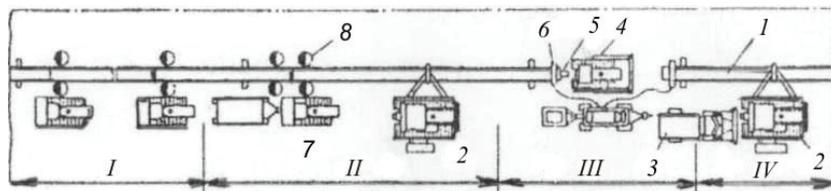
Специализированный сварочно-монтажный поток:
